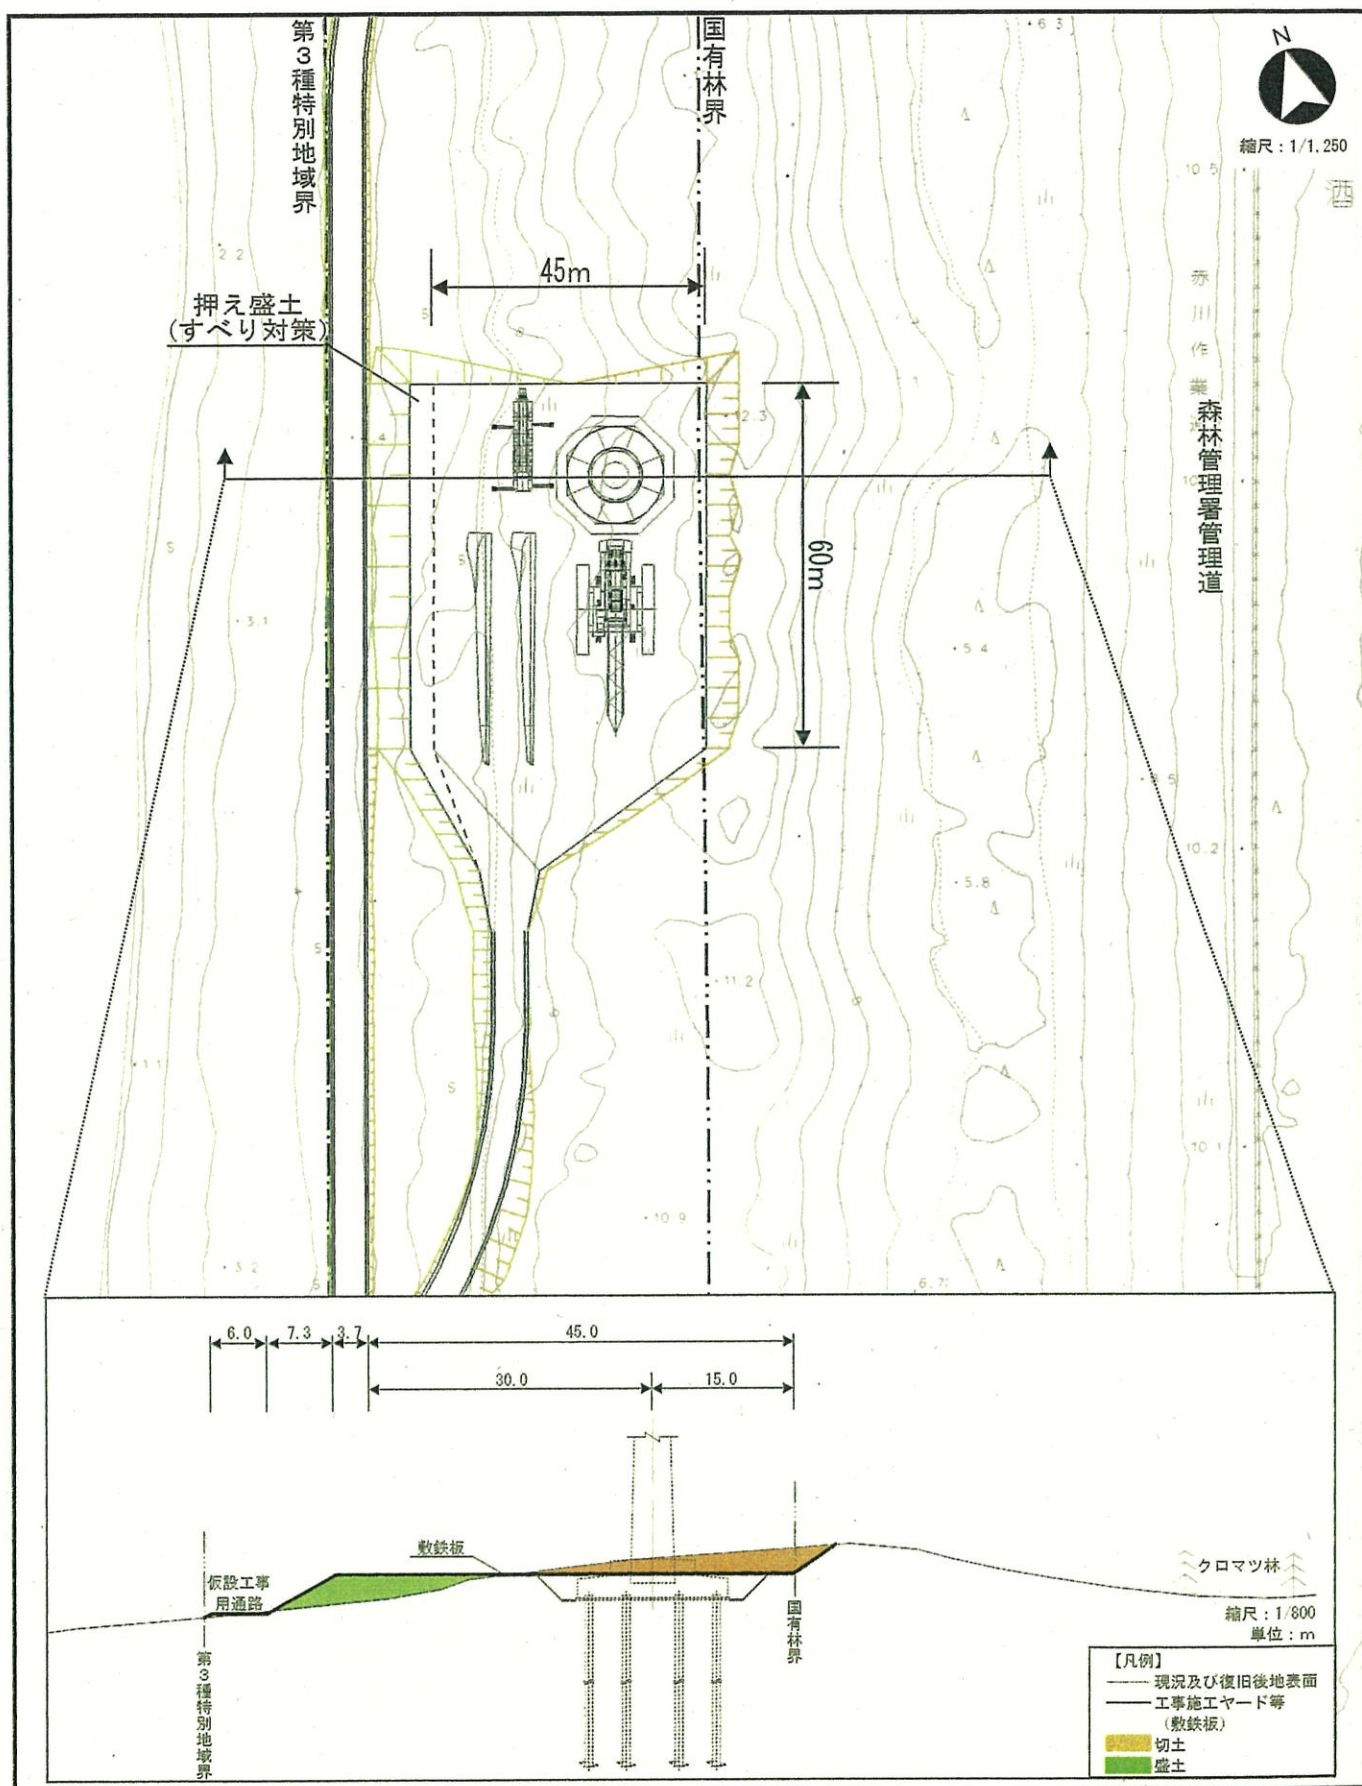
(3) 仮設ヤード等平面図 (設置時) (2号機)
